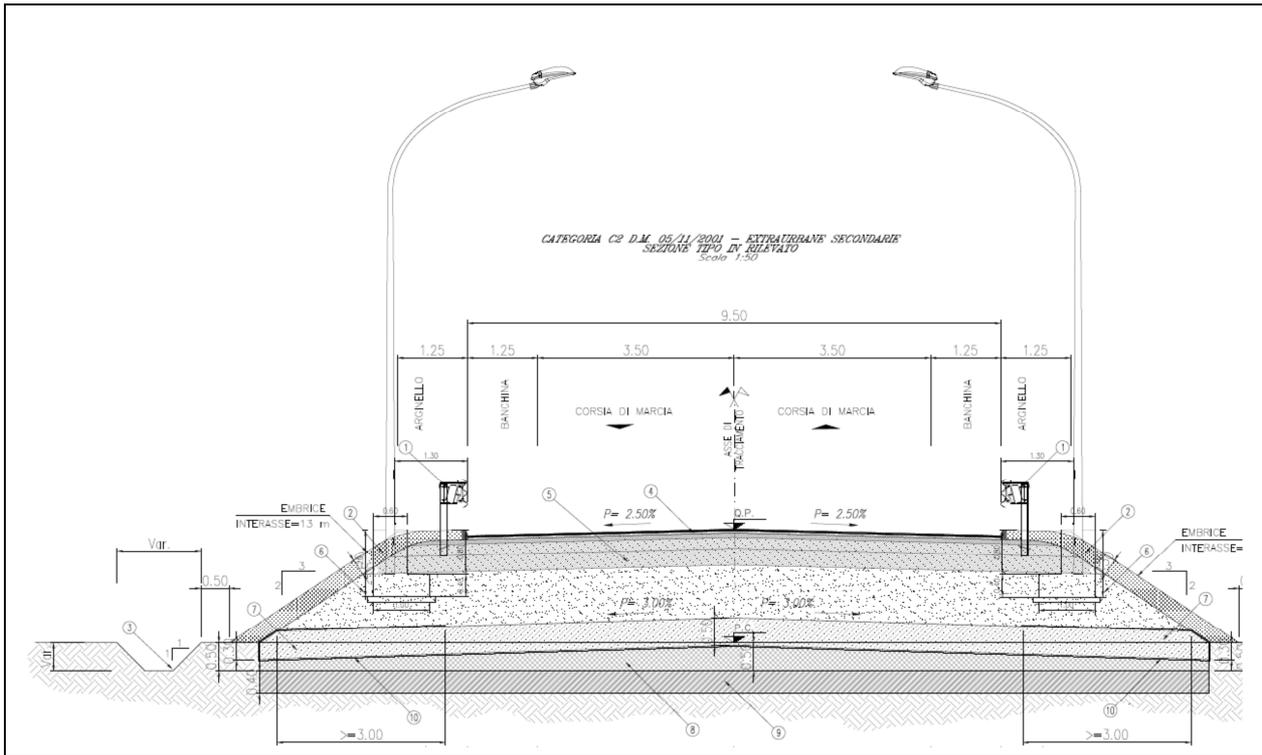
Sezione tipo in rilevato viabilità di progetto Categoria C2
